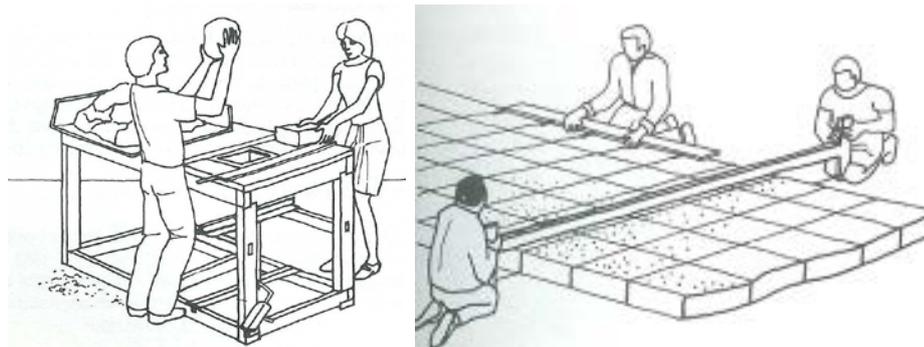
Outras formas de produção de adobes (Guillaud; Houben, 1989)
